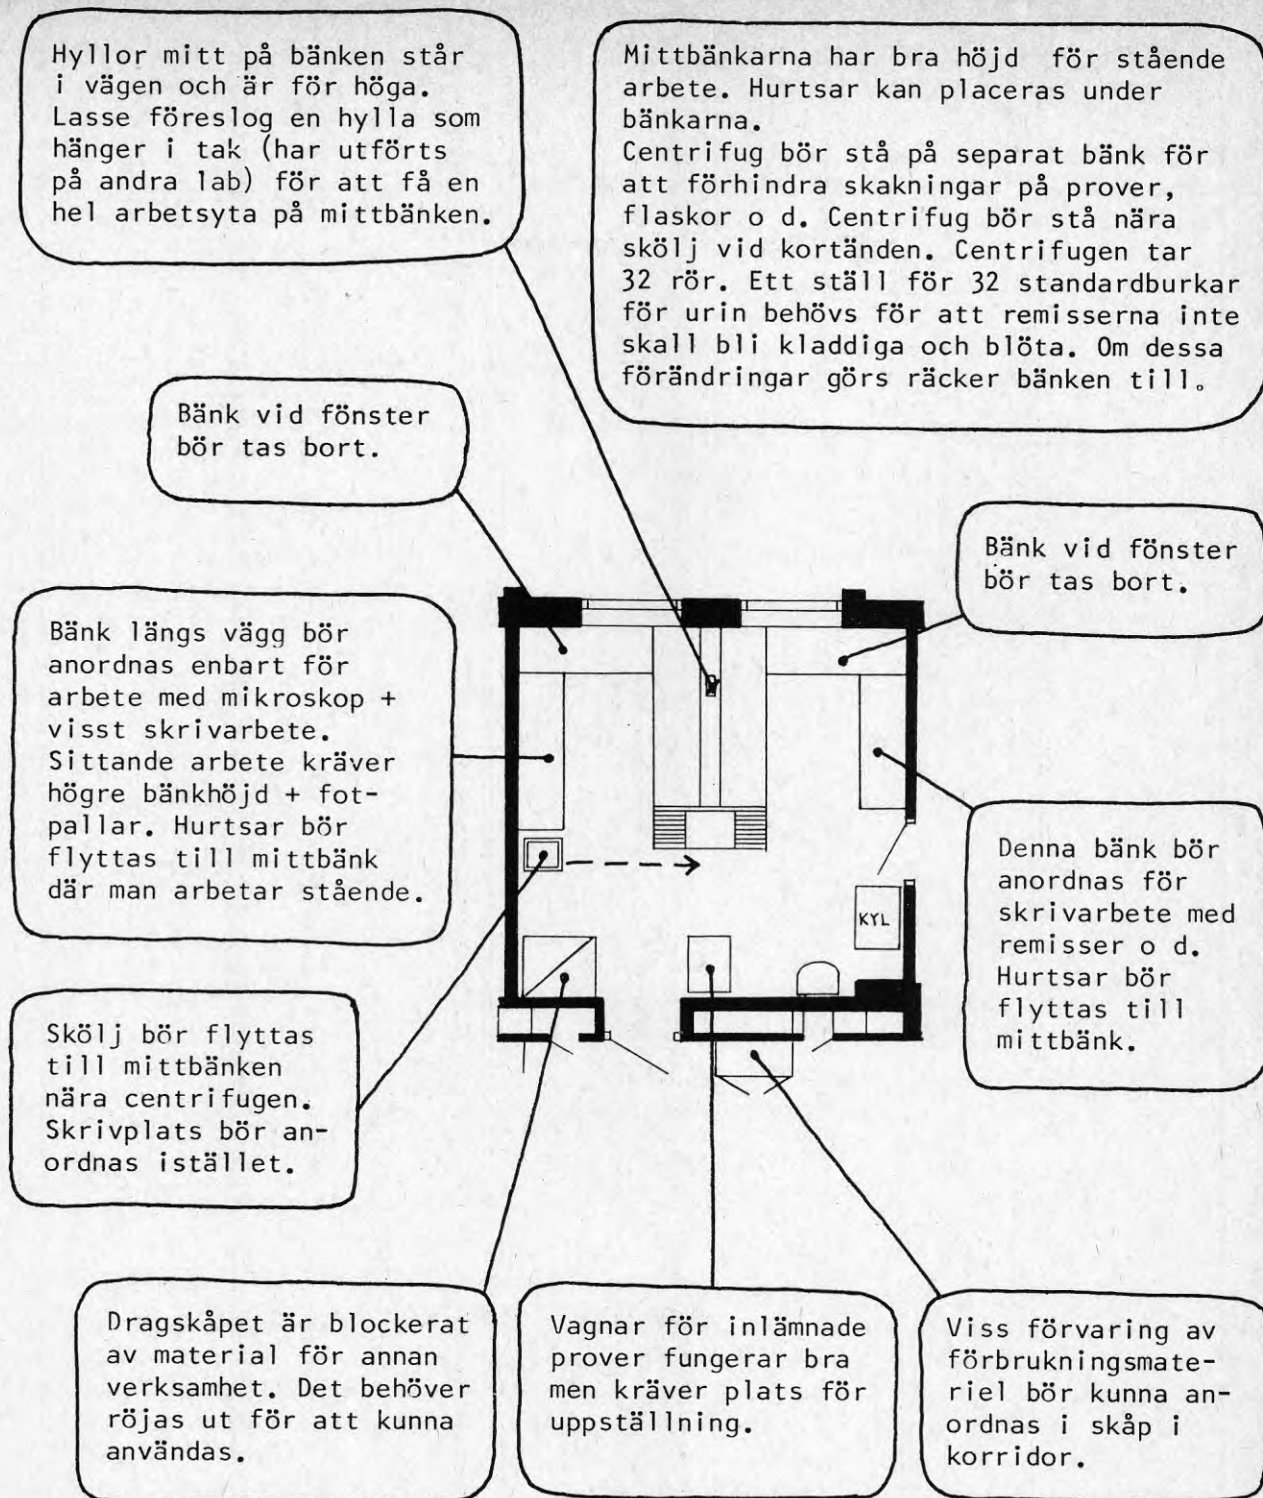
Urinlab. Plan skala 1:100.
